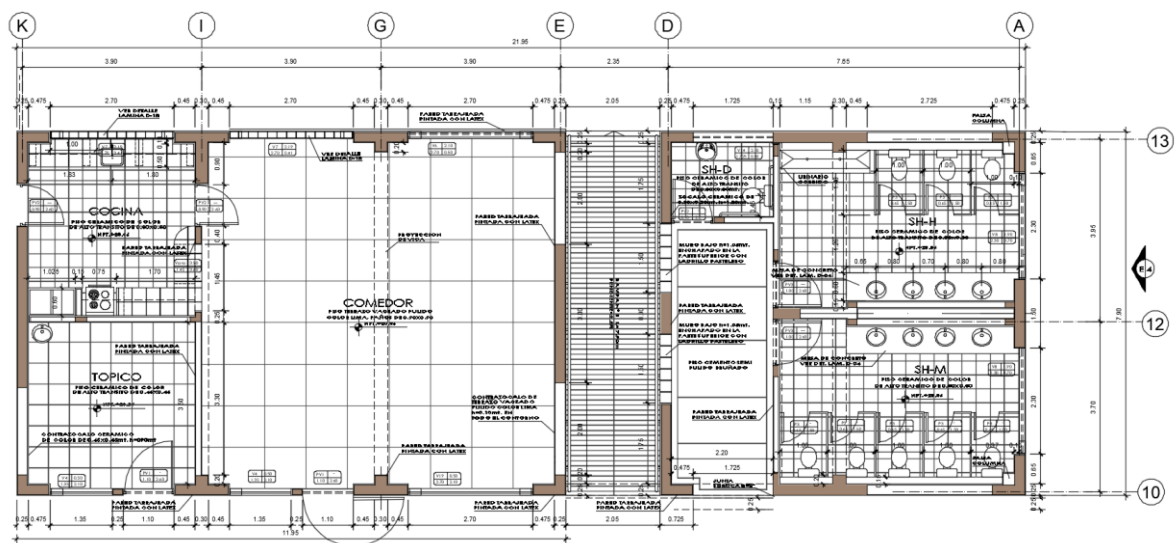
Distribución en planta del bloque "B". Fuente: Elaboración Propia.
